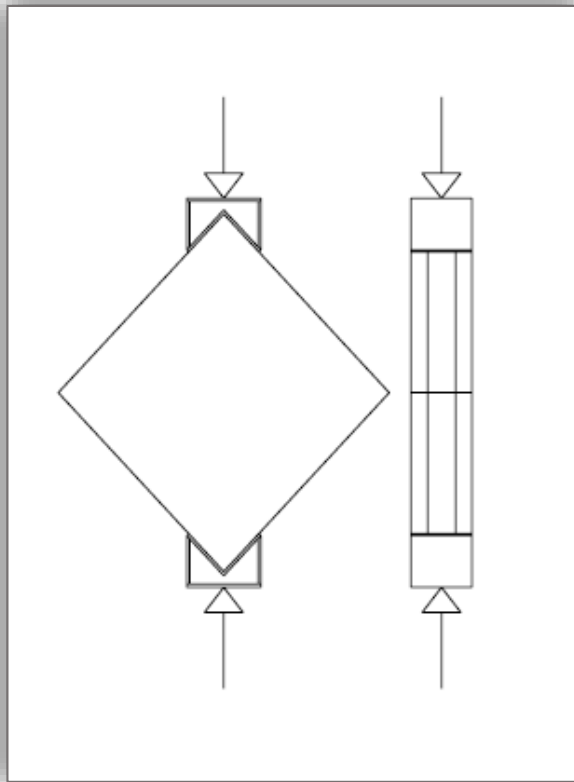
muro di dimensioni ridotte, layout prove di compressione diagonale
